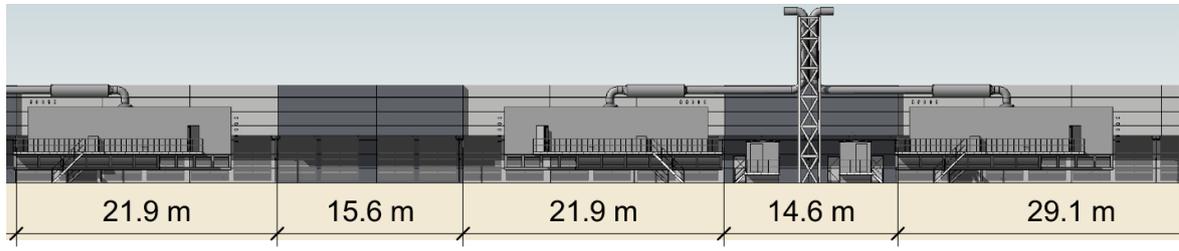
Concetto di suddivisione facciate - Prospetto
